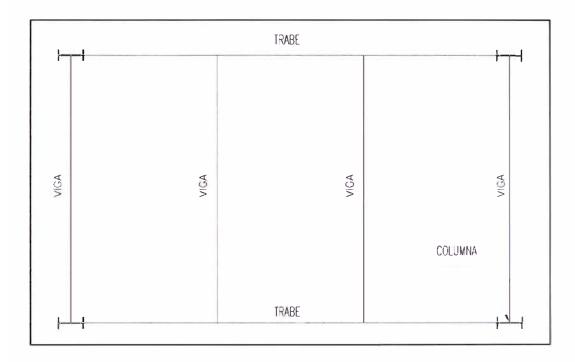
Construcción reticular con vigas y columnas. Vista de planta.
